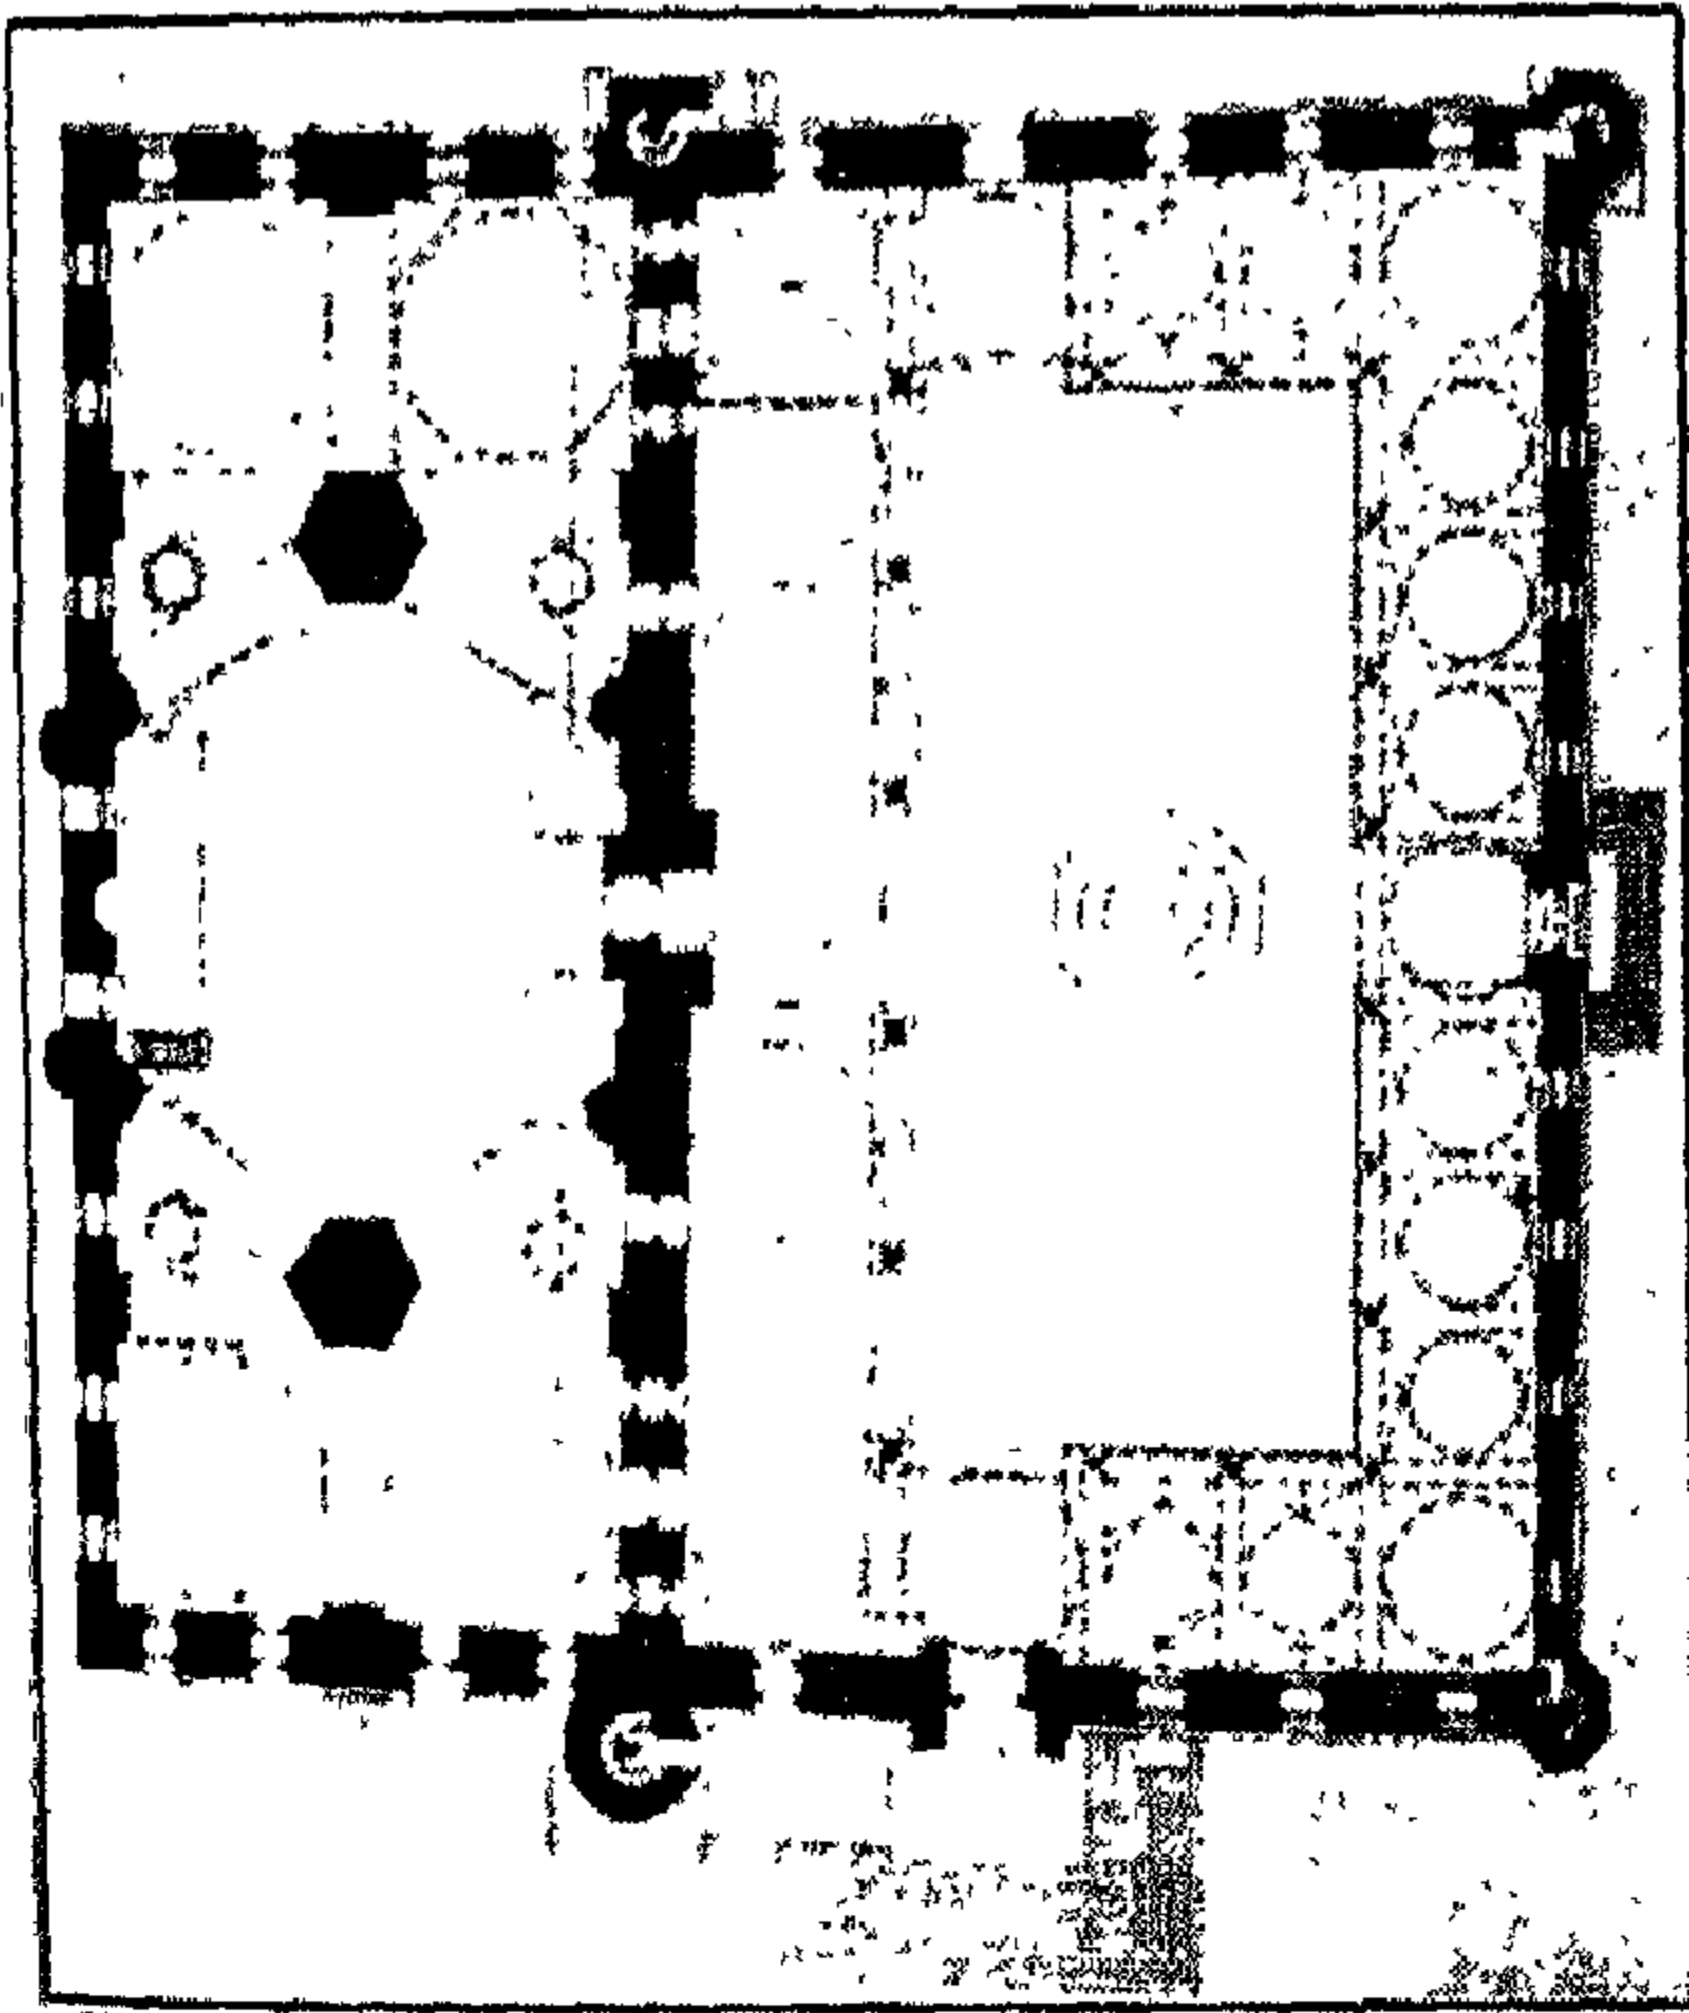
مسجد الصالح طلائع (مسقط أفقي)
